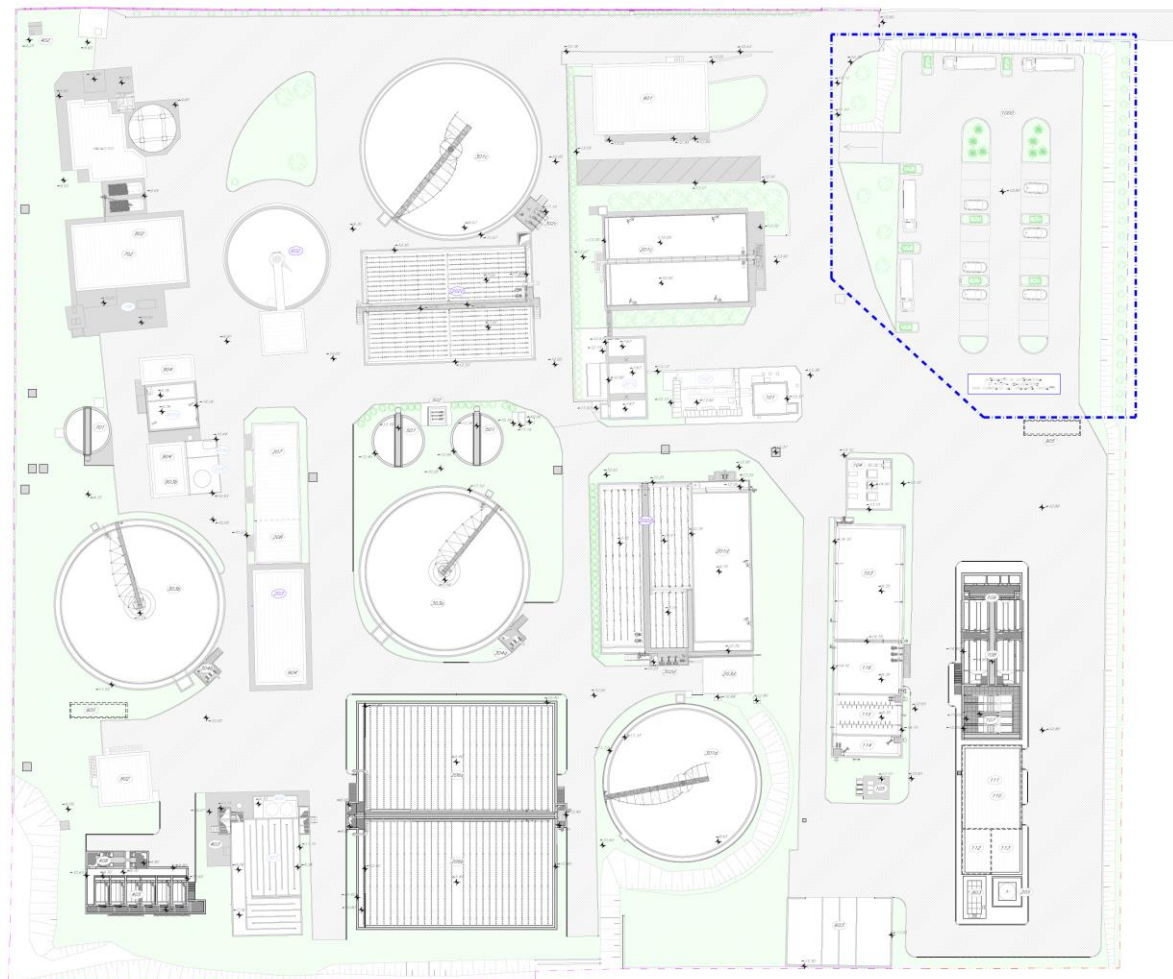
Configurazione di progetto (in blu area sistemazione di futura realizzazione non compresa nel presente progetto)
